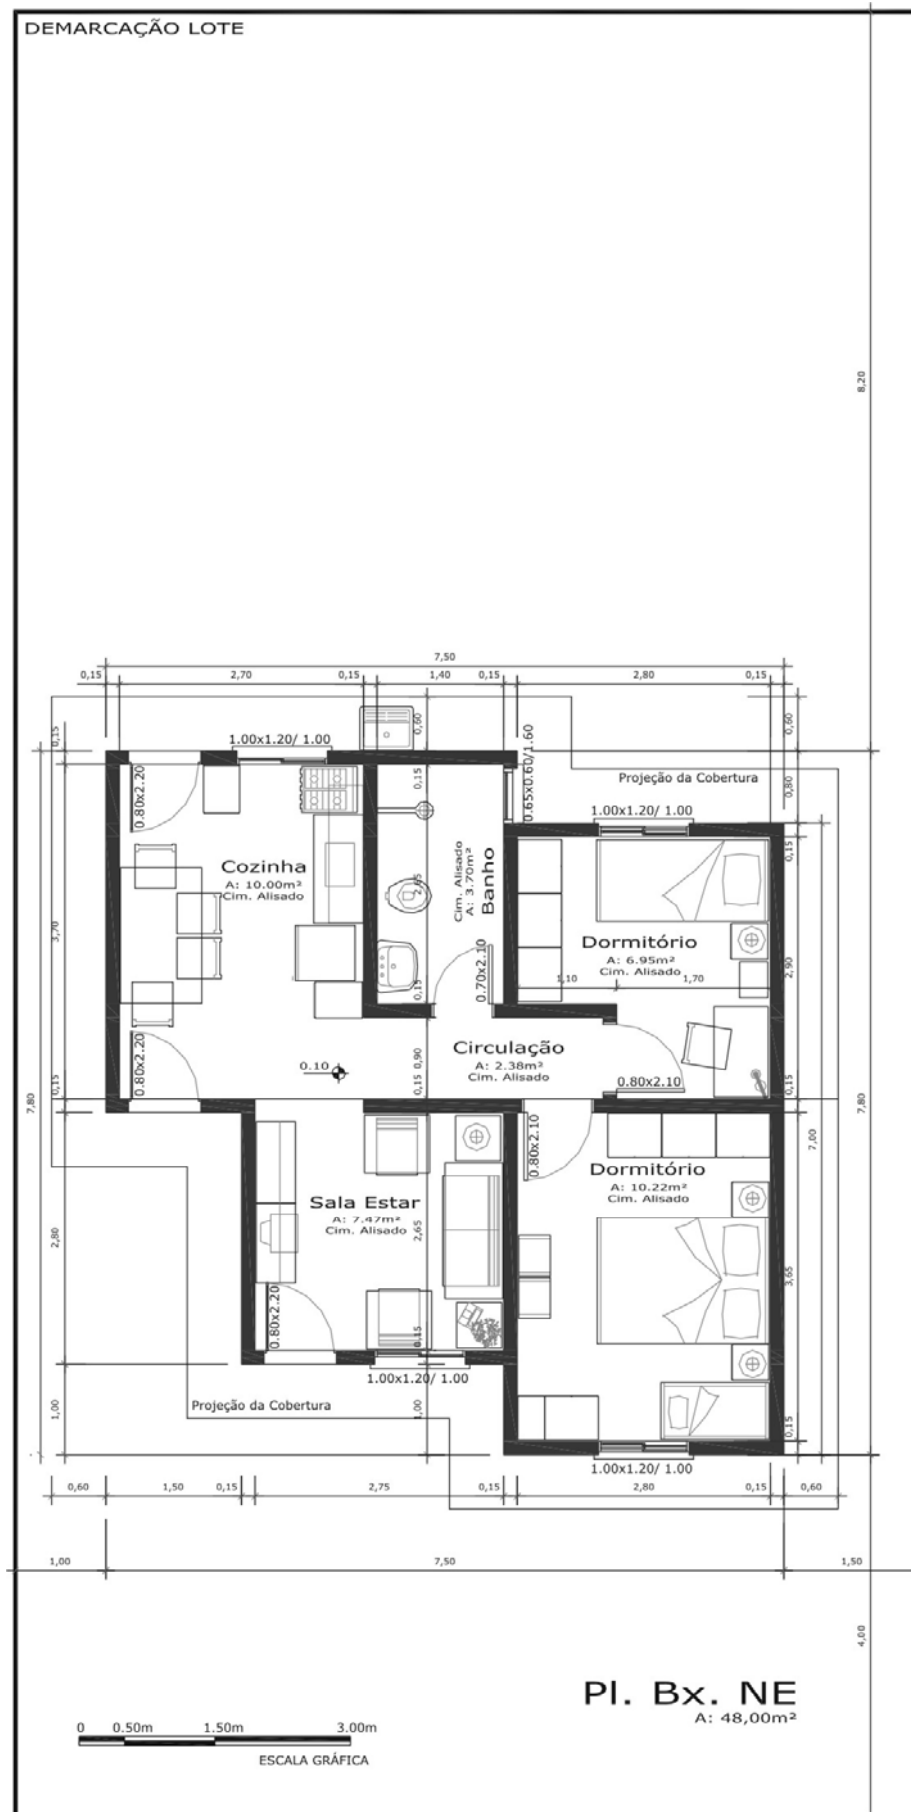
Sistema Construtivo em Alvenaria - Planta Baixa – Área: 48,00 m².
